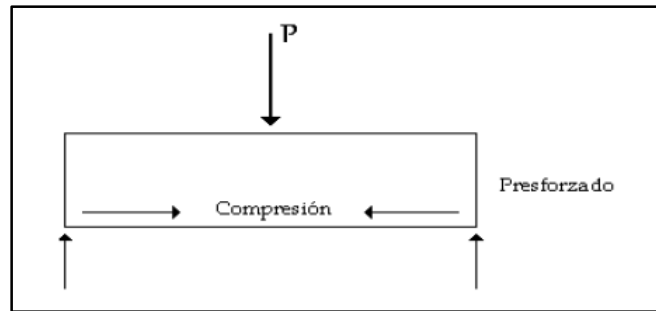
Imagen de una viga de concreto pretensada sometida a una carga P.
